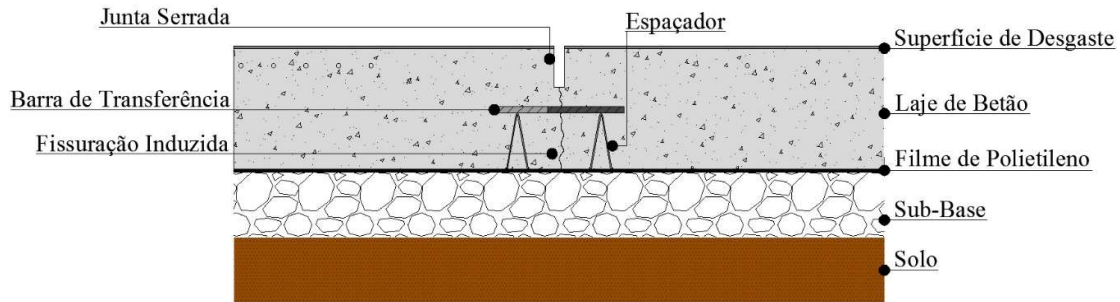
Esquema ilustrativo de um pavimento de betão simples (Adaptado de João, C., 2014)
